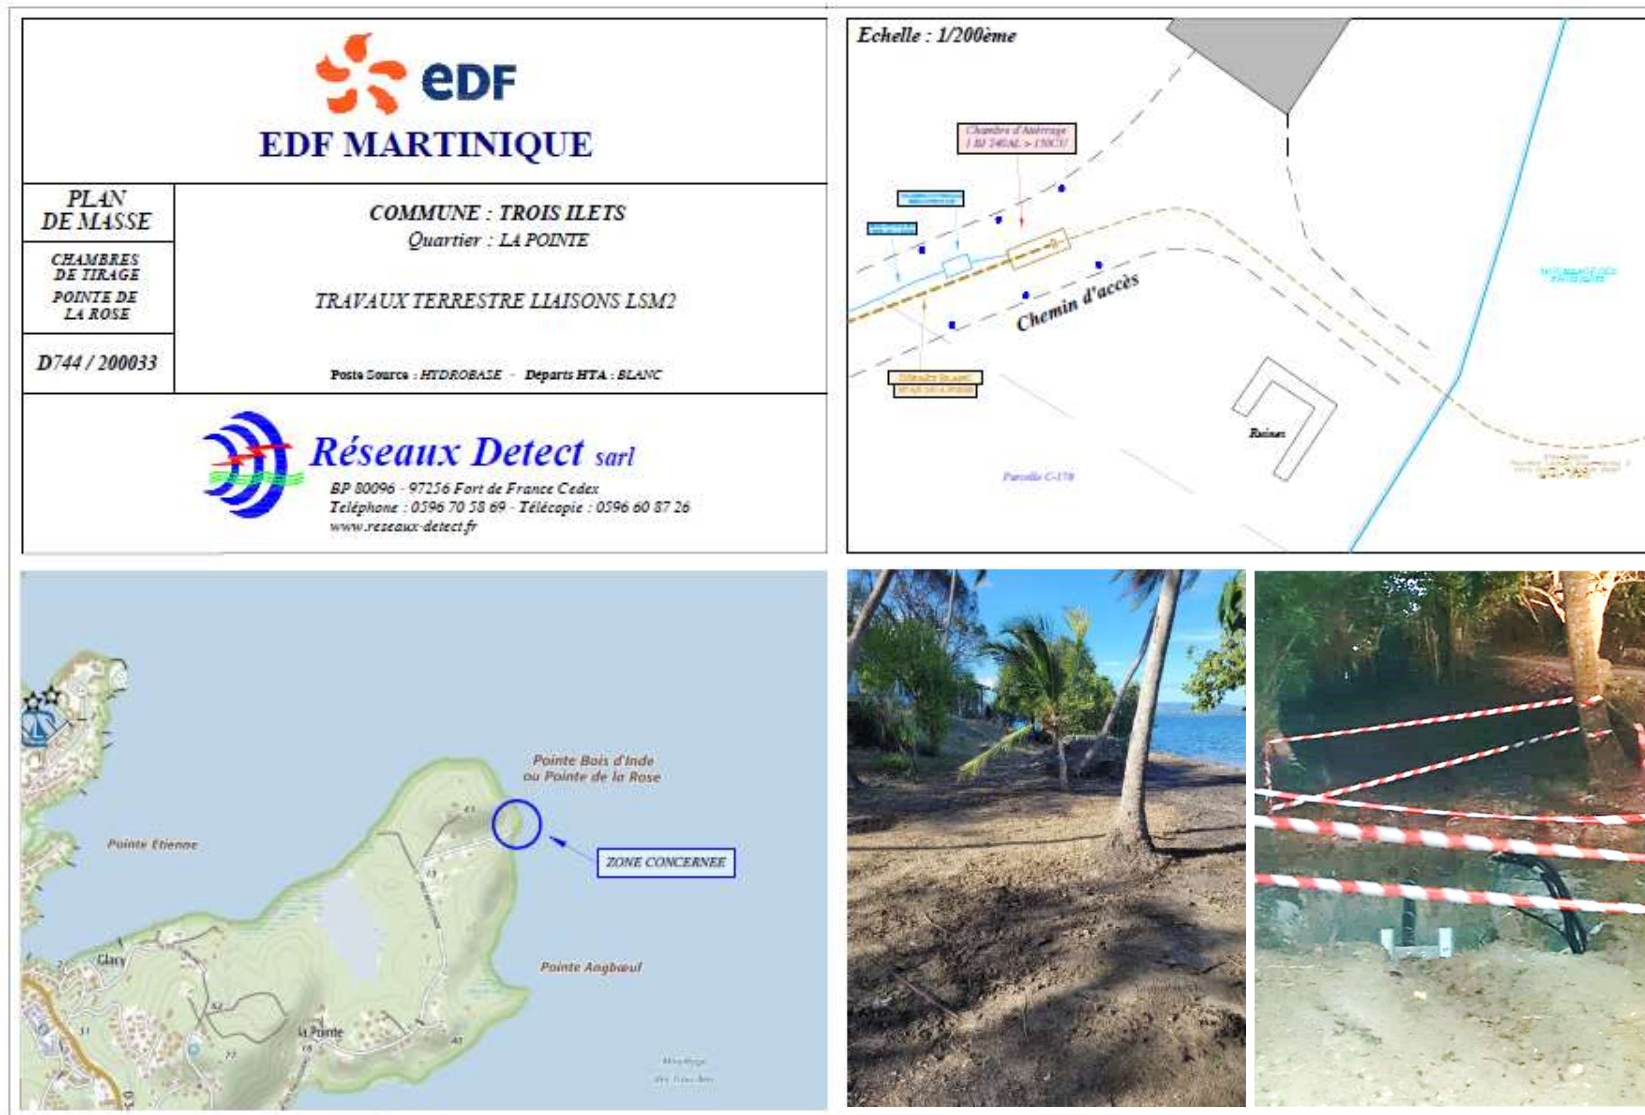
PLAN MASSE DE LA ZONE D'ATERRAGE DE LA POINTE DE LA ROSE
